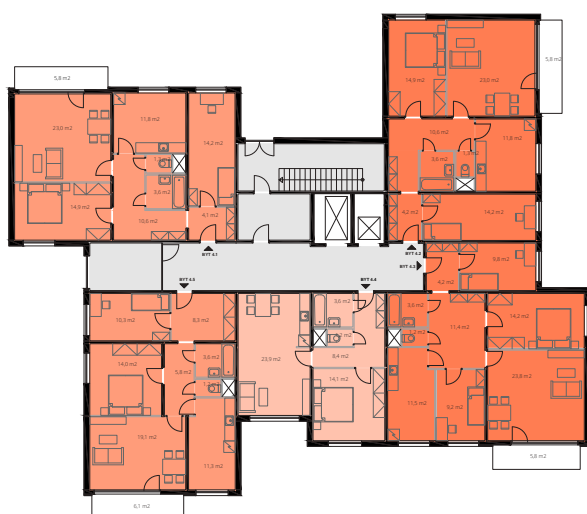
Konstrukční soustava B70 - Brno Vinohrady (Zdroj: panelaky.info)
